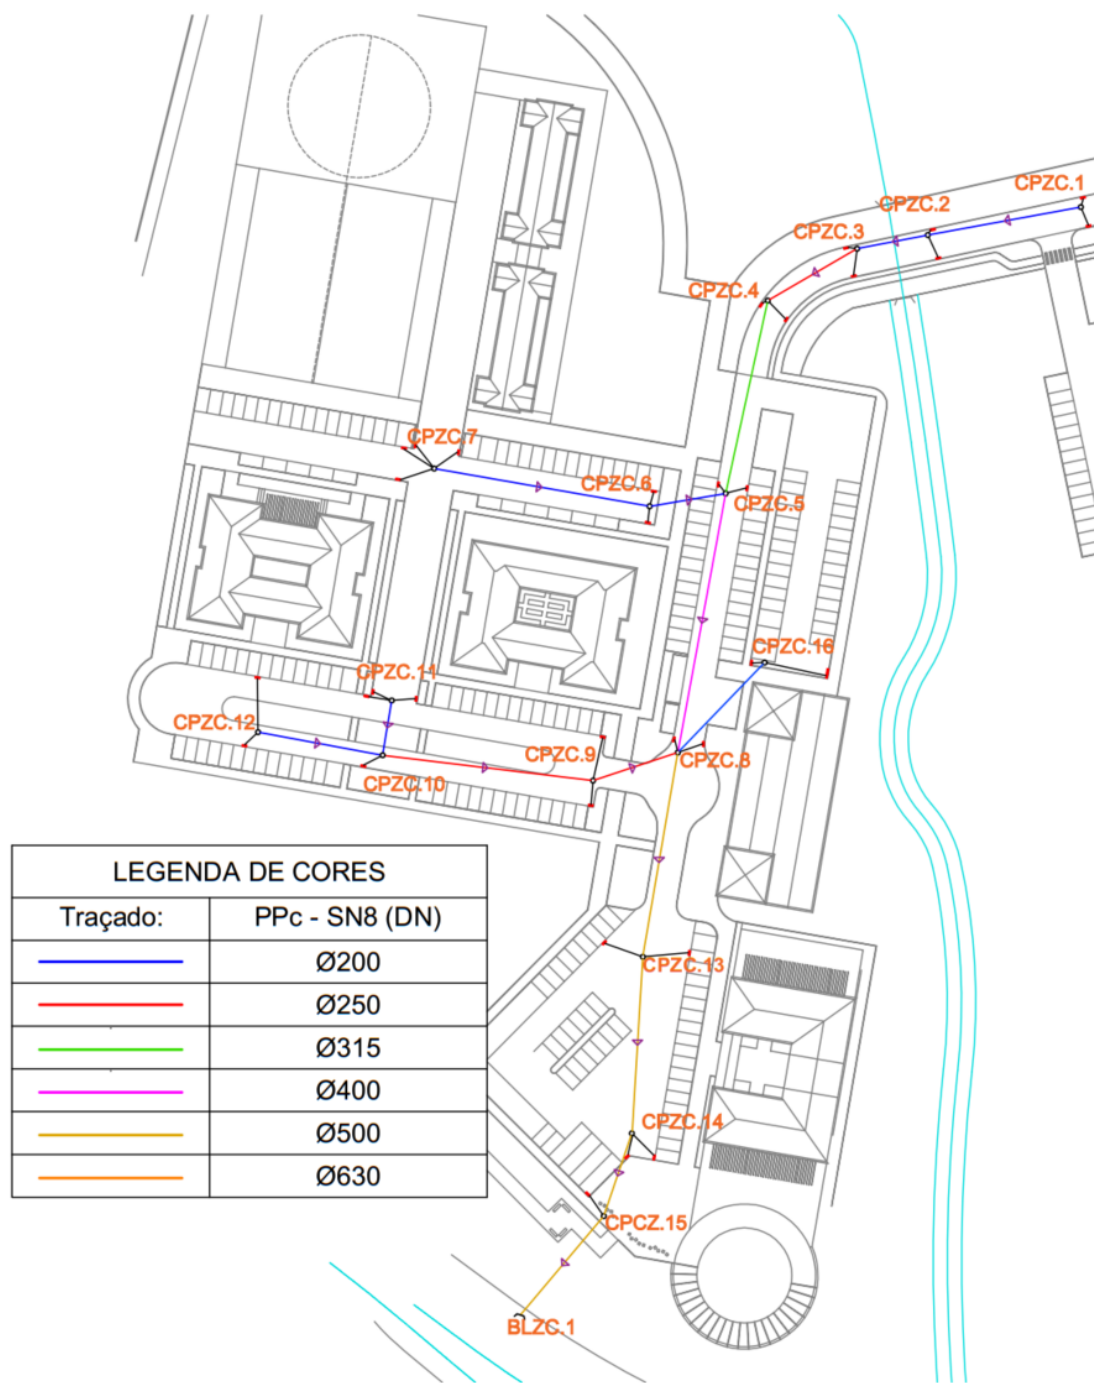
Planta do traçado da rede de drenagem das águas pluviais da Zona Comunitária com os diâmetros dos coletores identificados com recurso a uma escala de cores.
